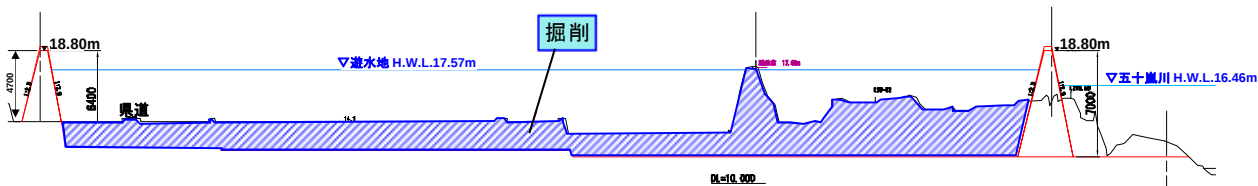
遊水地①（5.6k 左岸）横断面図
